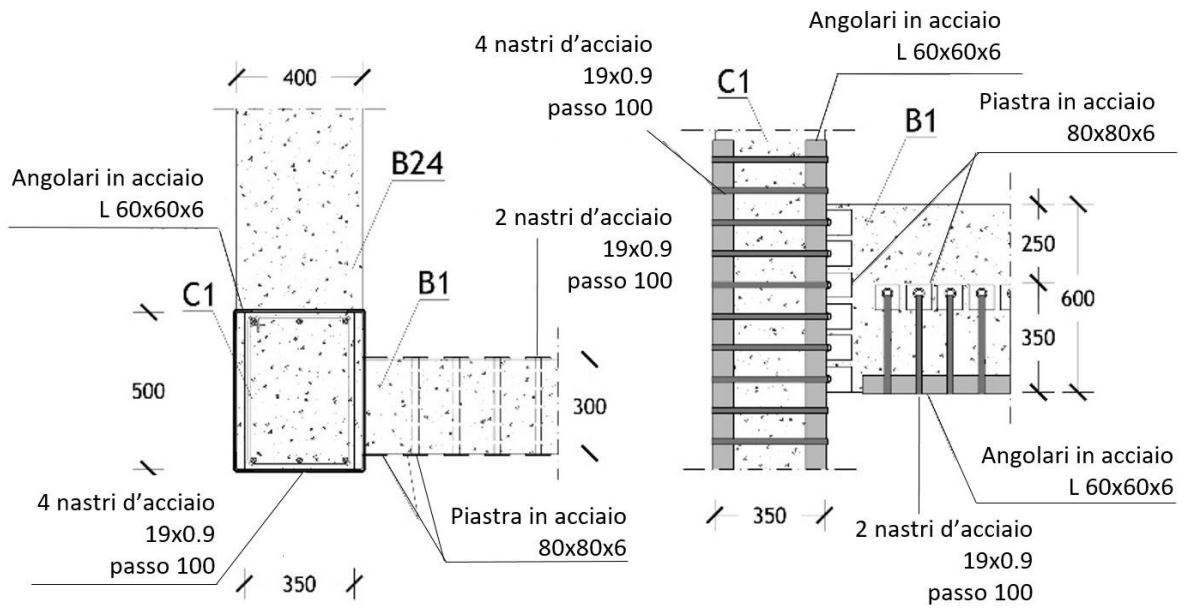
Sezione orizzontale e prospetto del nodo B appartenente al primo impalcato
